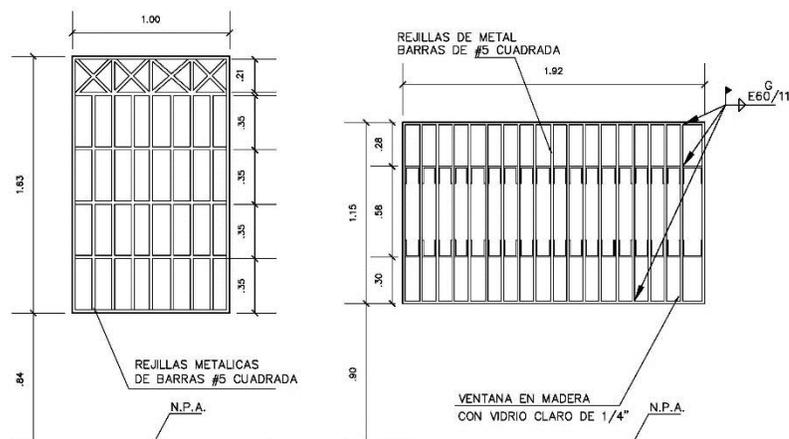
Detalle de anclaje de ventanas y puertas de hierro.
